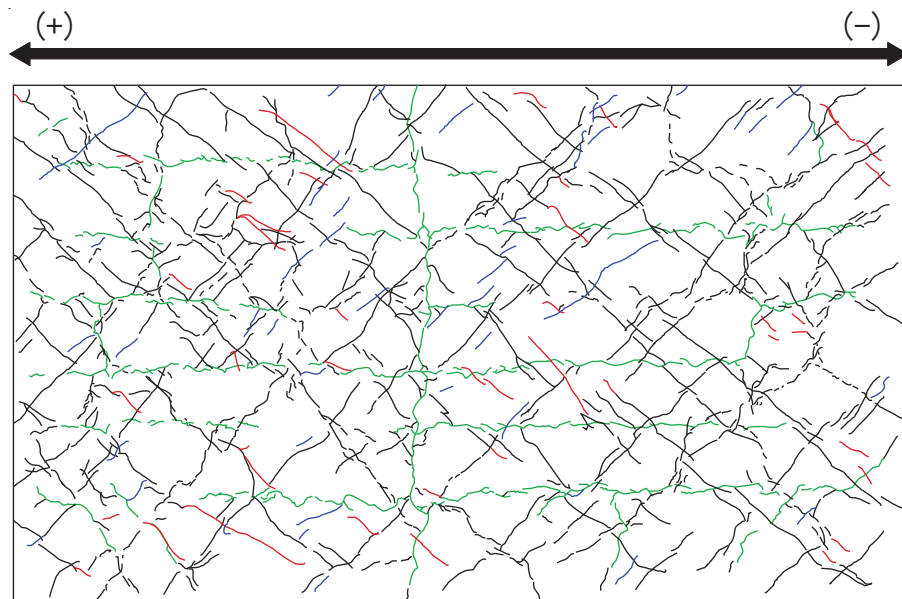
乾燥試験体 [1] 最終破壊時ひび割れ図
